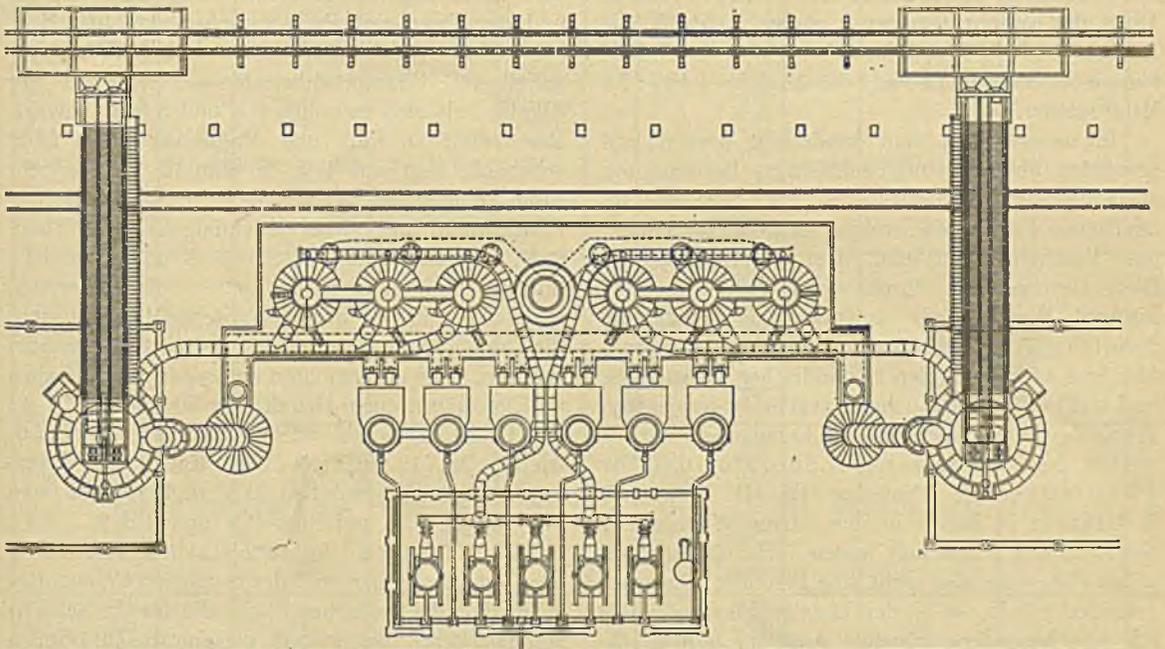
Lageplan der neuen Hochofenanlage in Columbus, Ohio.
